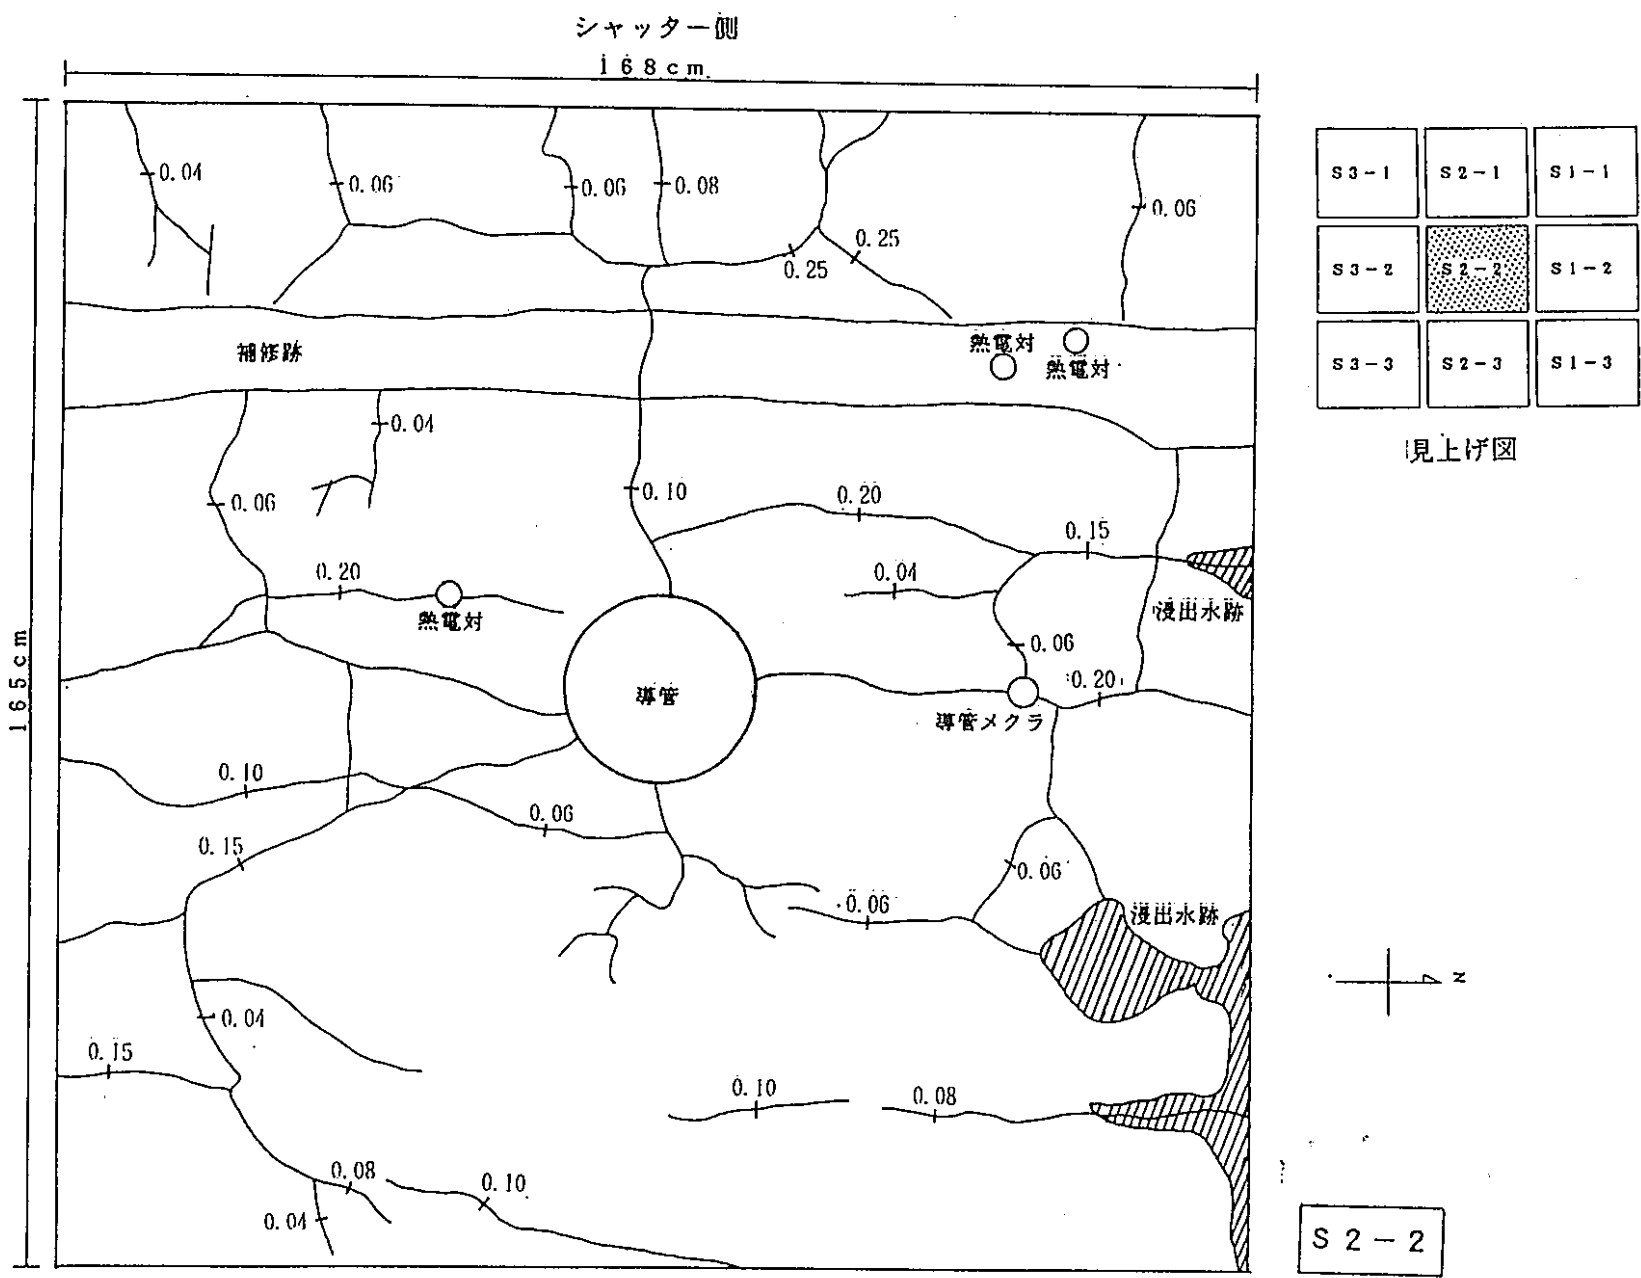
6 ひび割れ観察図 (S2-2)
